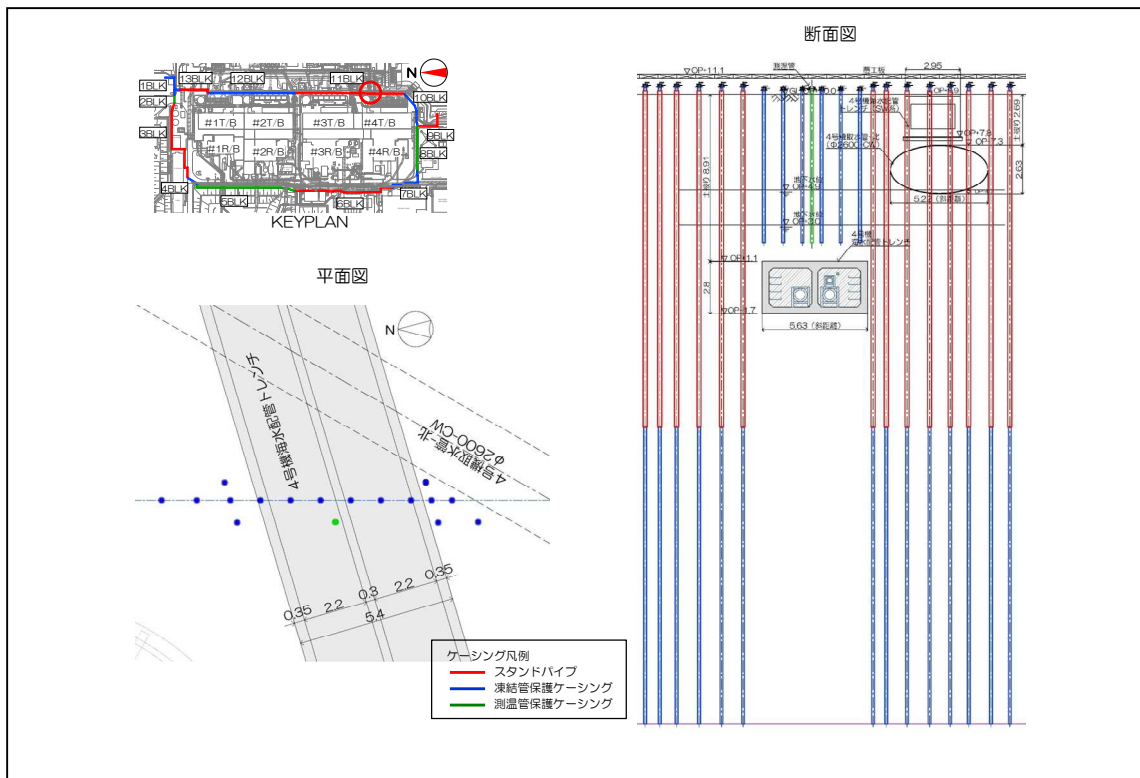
4号機海水配管トレンチ部 施工平面図・断面図
